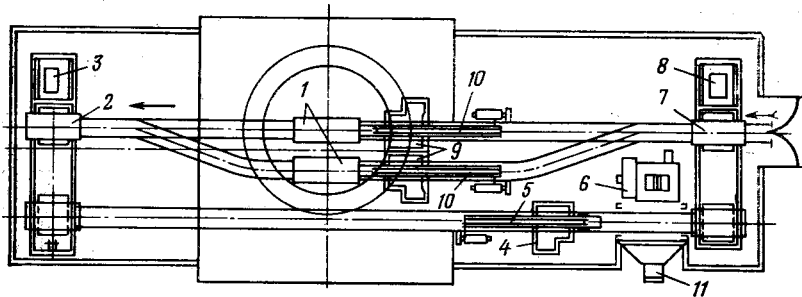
Схема обмена вагонеток с поперечными перекатными платформами
